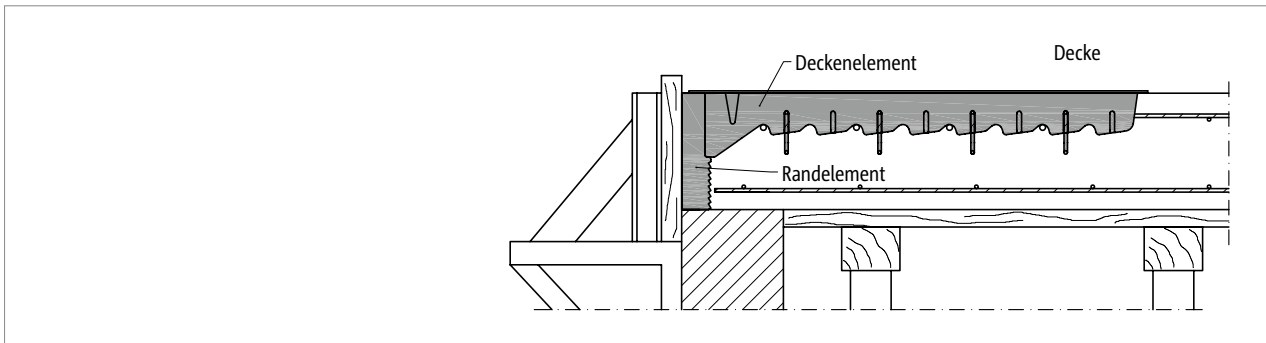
Schöck IDock®: IDock1, Außenwand als direktes Auflager; die Deckenaussparung wird durch die beiden Komponenten Randelement und Deckenelement abgeschalt
